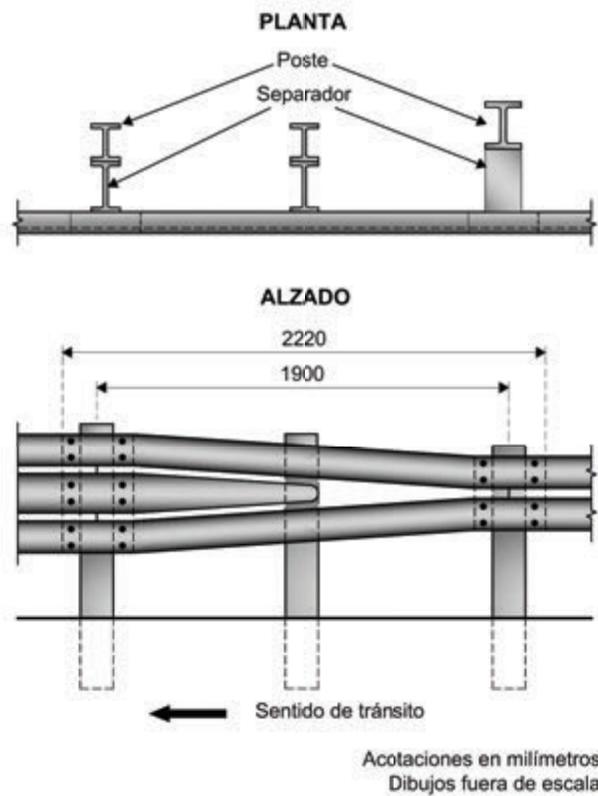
Sección de transición para unir vigas acanaladas de dos y de tres crestas
